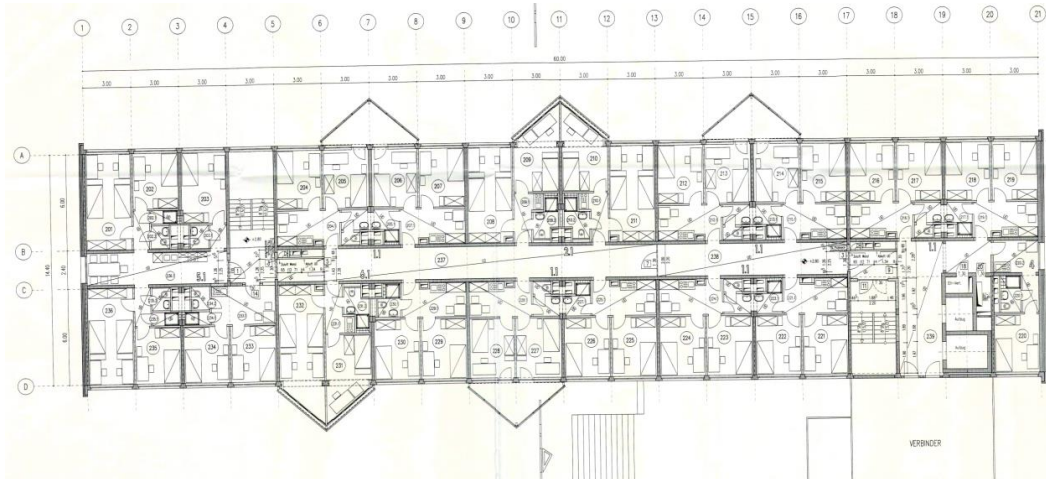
Ausschnitt aus [4] Grundriss 1. Obergeschoss
